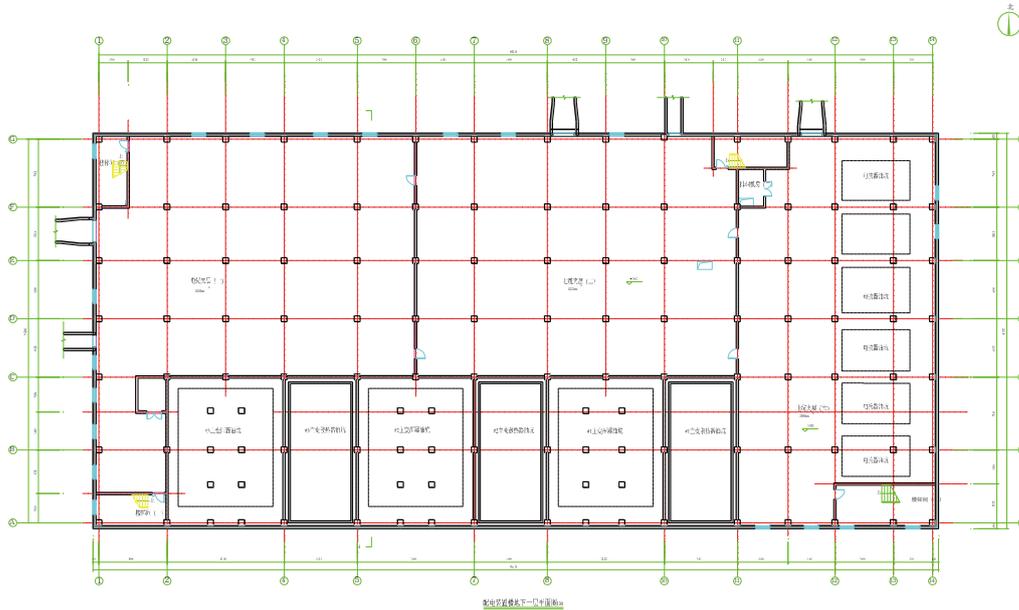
TJ-220-A2-4 方案电缆夹层平面布置图
